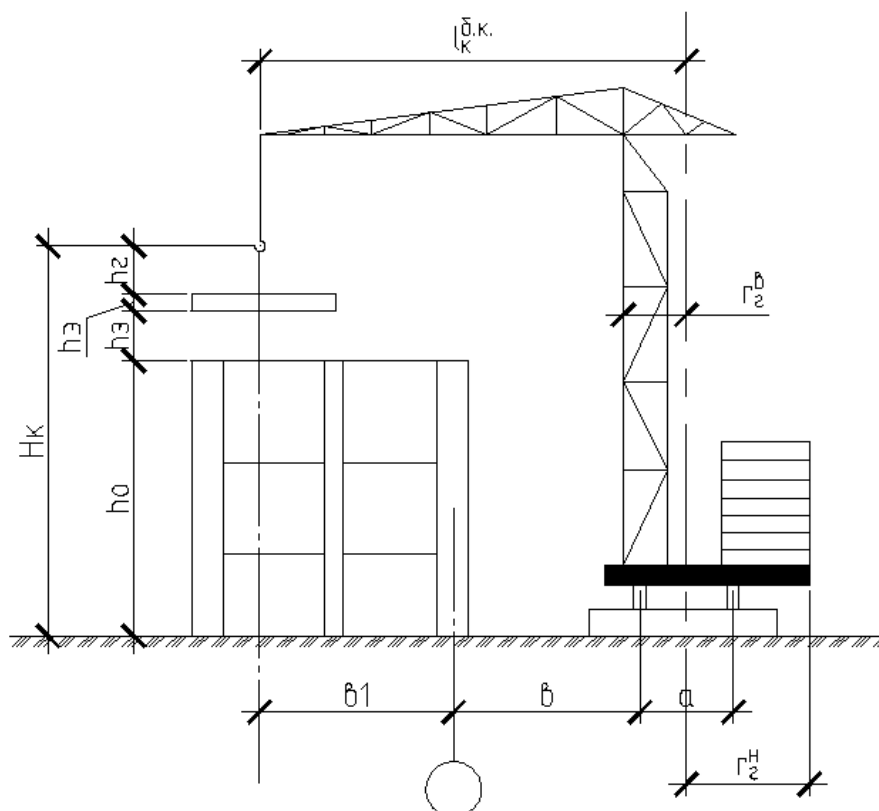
Схема монтажа конструкций башенным краном
